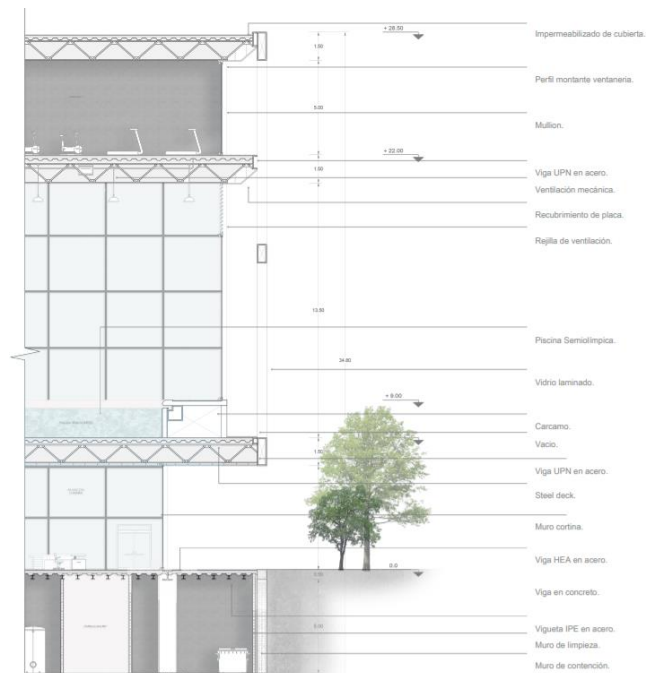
Corte fachada con descriptores (fuente: elaboración propia.)
